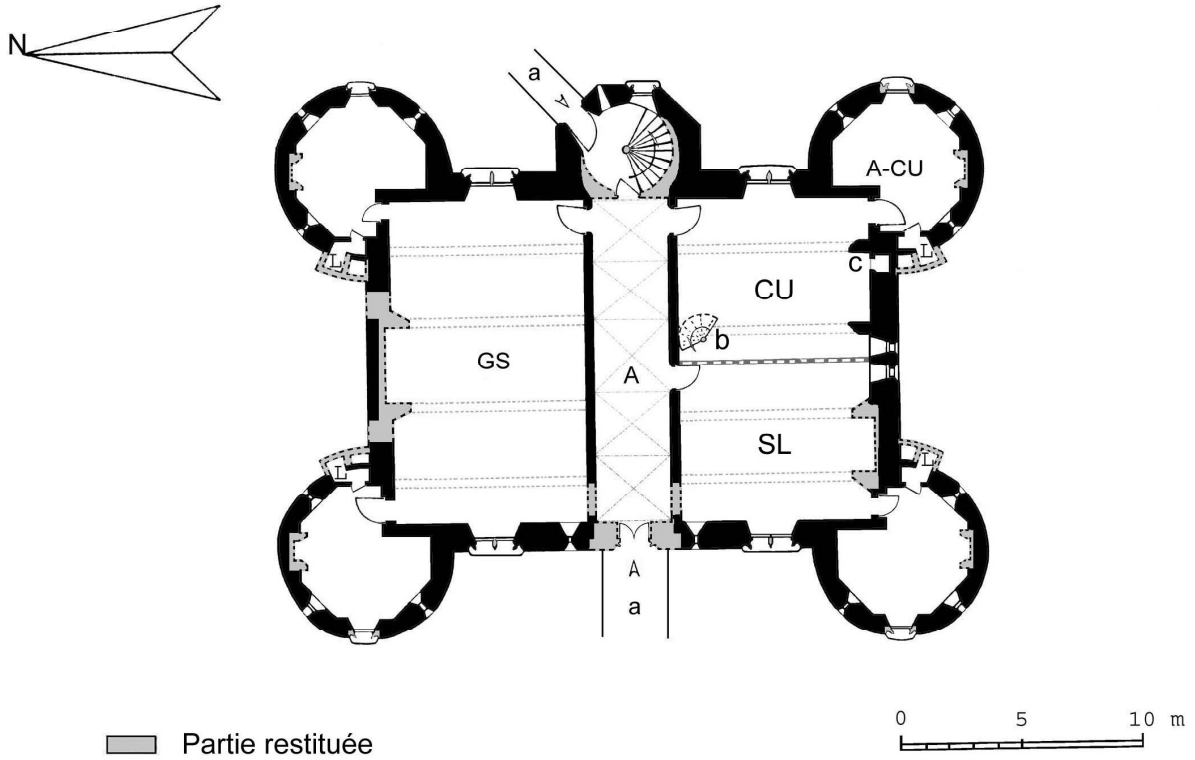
Martainville. Plan restitué du rez-de-chaussée vers 1495.
